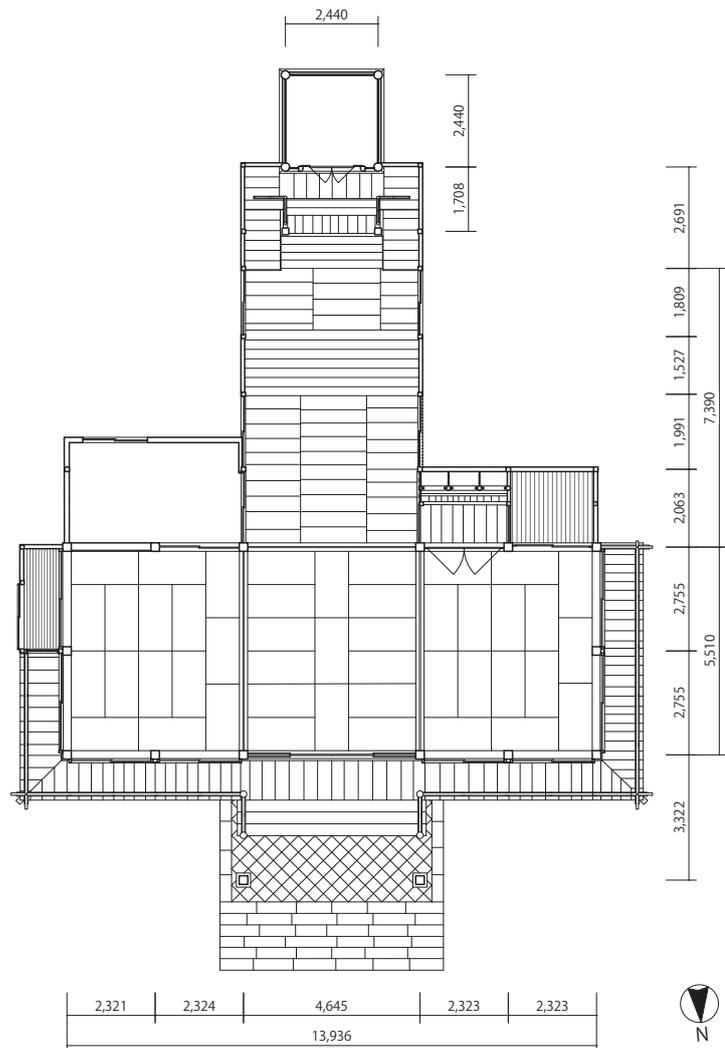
拝殿・幣殿・本殿平面図 1 : 200
